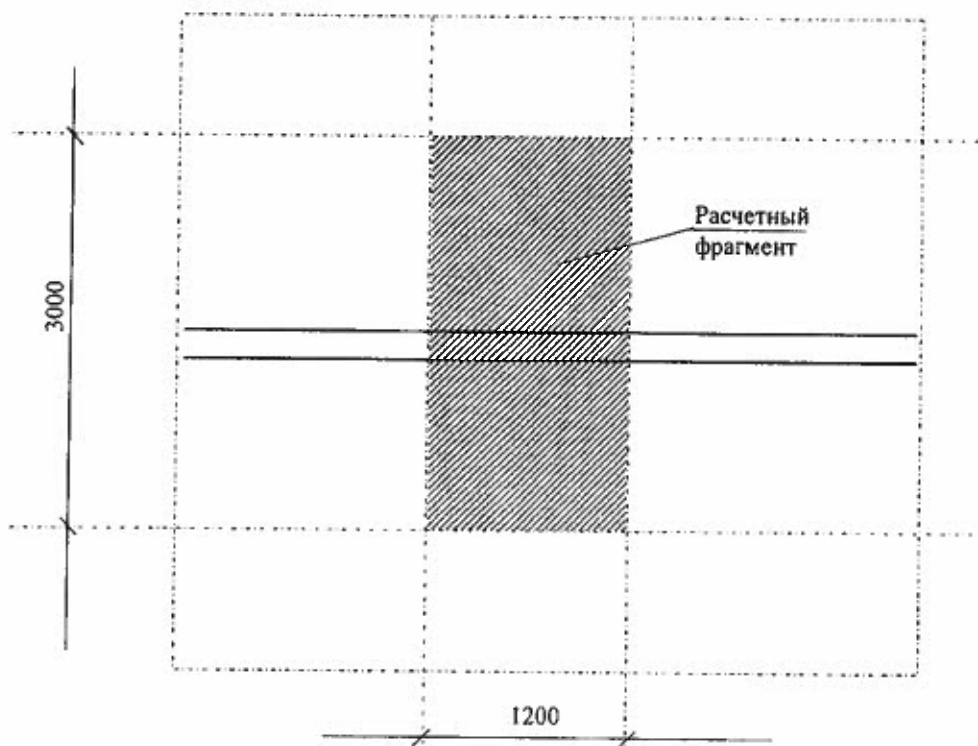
Расчетная схема фрагмента наружной стены здания для определения приведенного сопротивления теплопередаче участка без проемов (вид со стороны помещения)
